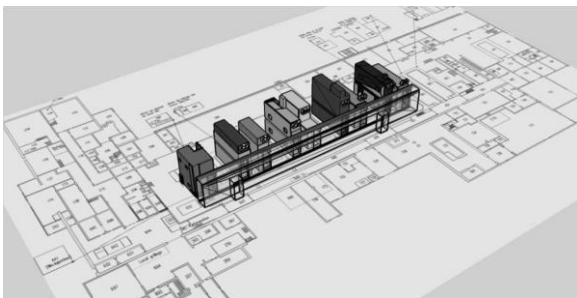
Croquis d'implantation de cellules Haute Activité (HA) sur le plan de masse de l'installation Atelier Pilote de Marcoule (APM)
